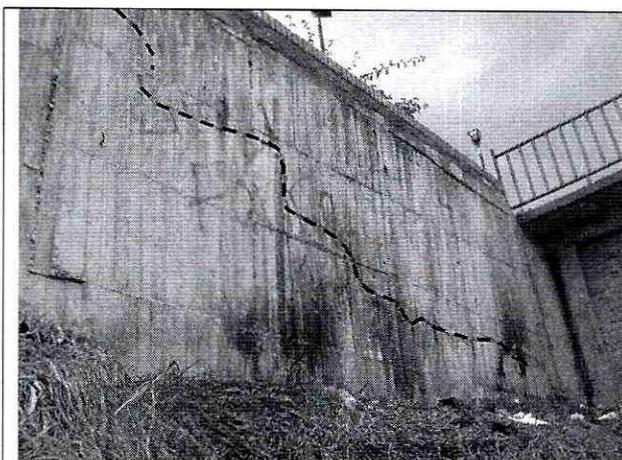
Grieta de tendencia diagonal escalonada en el sector sur del muro; se identificaron algunos sectores con leve desplazamiento horizontal.
